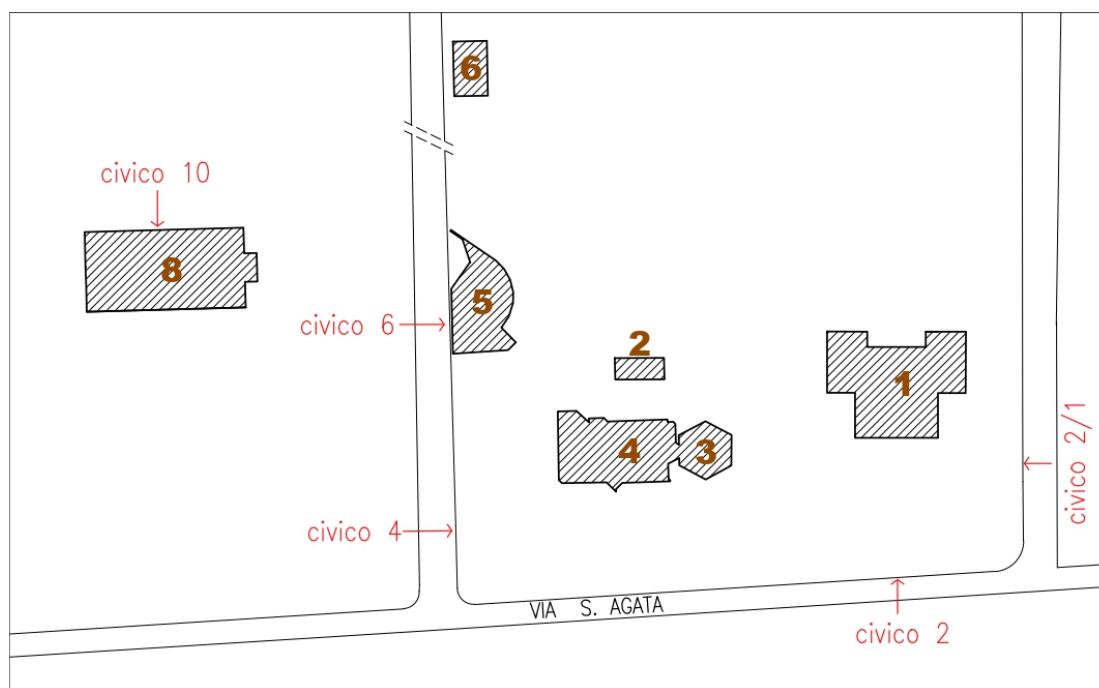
Planimetria con individuazione fabbricati esistenti e numeri civici secondo la classificazione predisposta in data 4.02.2006 dal Comune di Rubiera.
